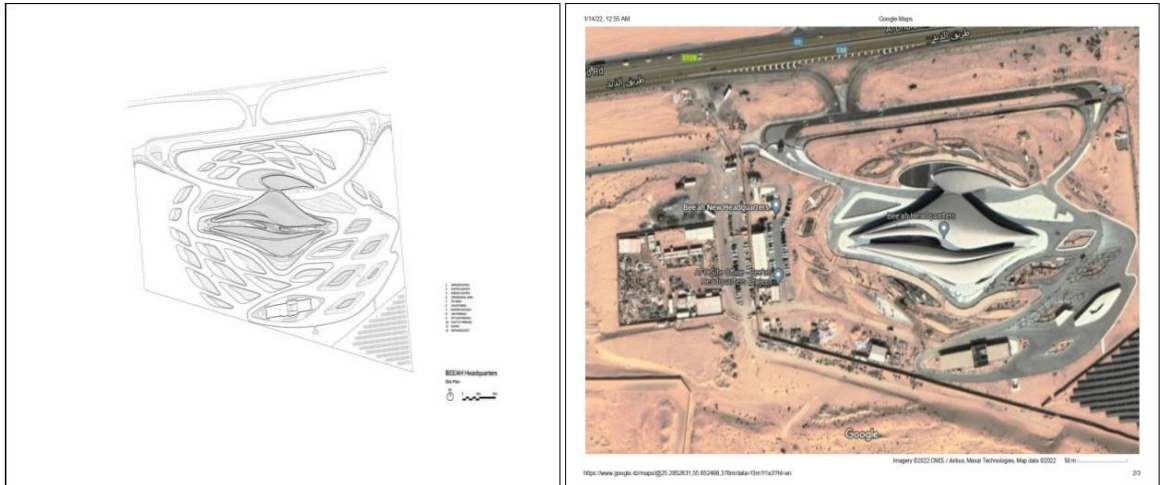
plan de situation +carte de google earth presente l'environnement de la siége de bee'ah
